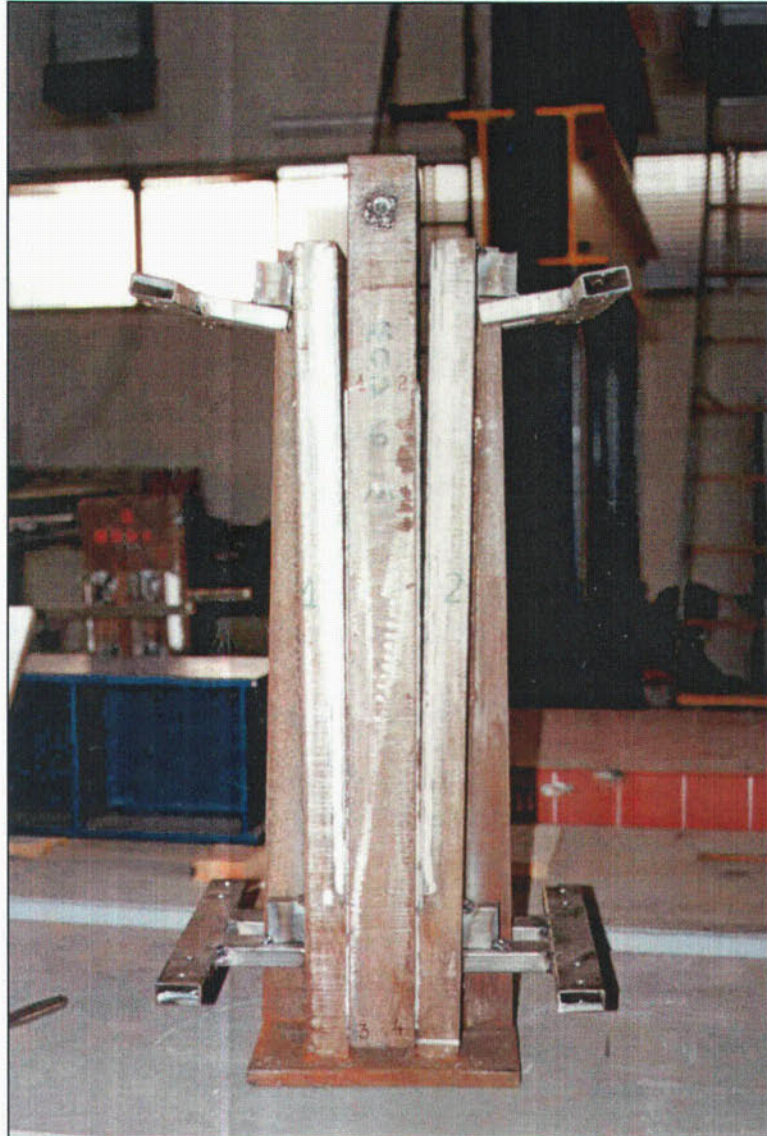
Detalle de la probeta 6M ya rota. Se encuentran completamente arrancadas las soldaduras 1-3 y 2-4. La rotura nuevamente se produce por la sección de garganta de las soldaduras.
